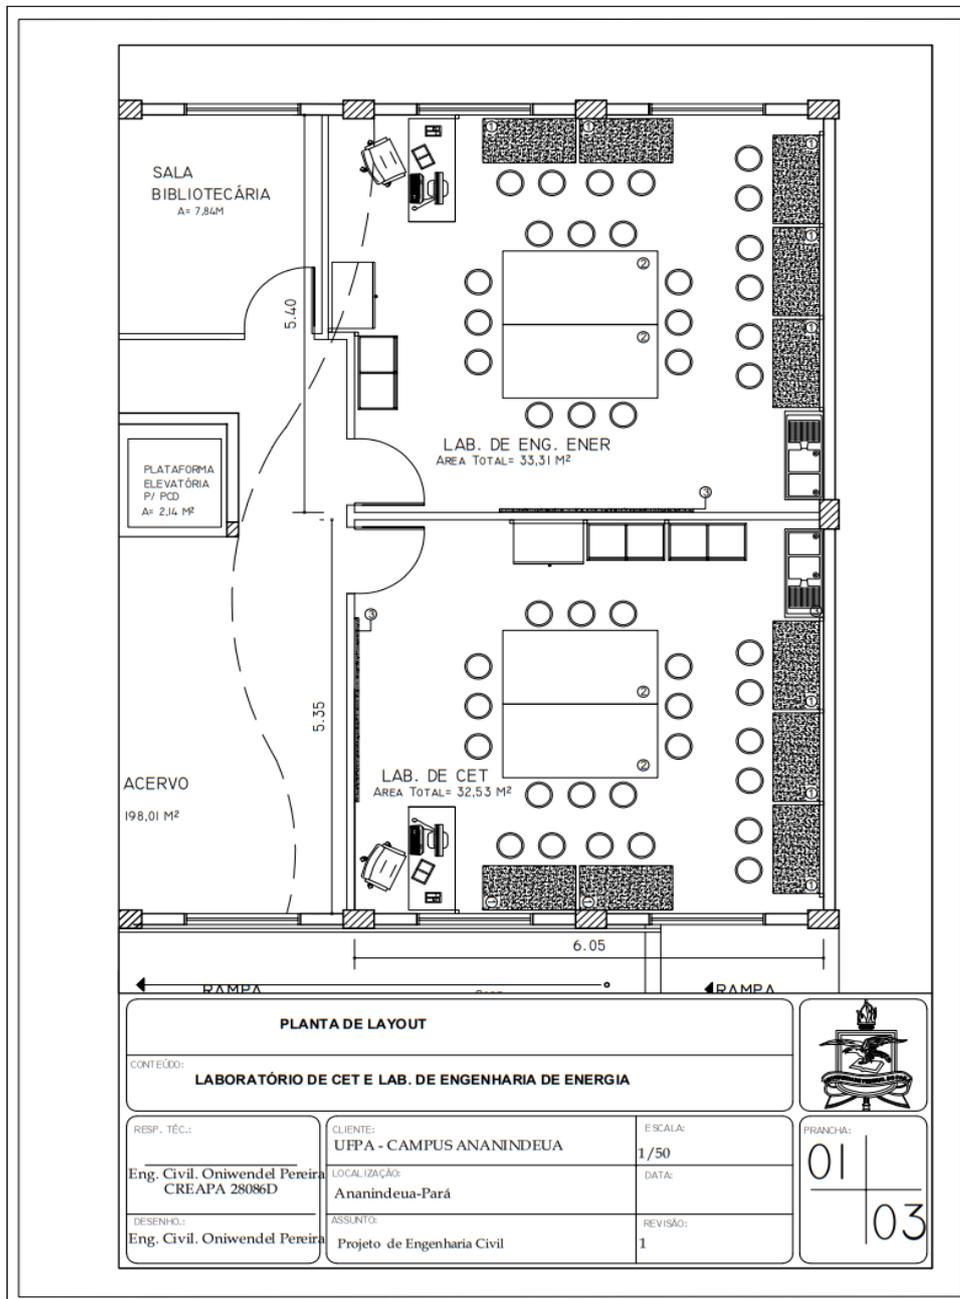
Planta baixa do prédio do Icuí-Guajará.
